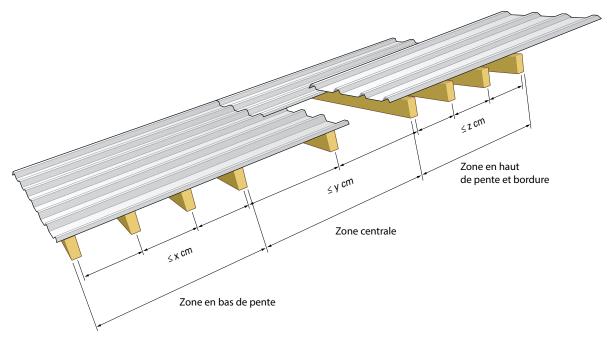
Exemple d'une toiture à un versant - définition de trois zones
